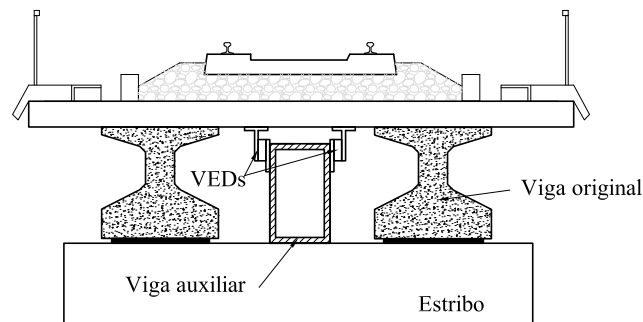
Sección transversal de puente de vigas de vía única con sistema de reacondicionamiento
